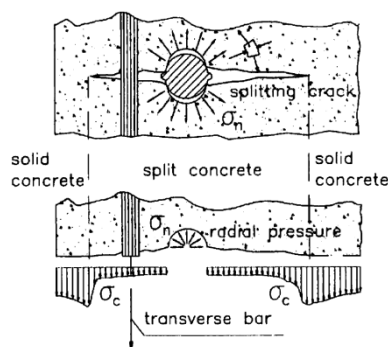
Fissure de fendage et action de confinement des aciers transversaux³²
